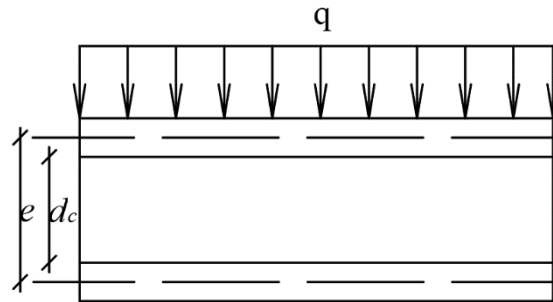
Dimensões de um tipo de painel sandwich com lâminas finas. Adaptado [27].
